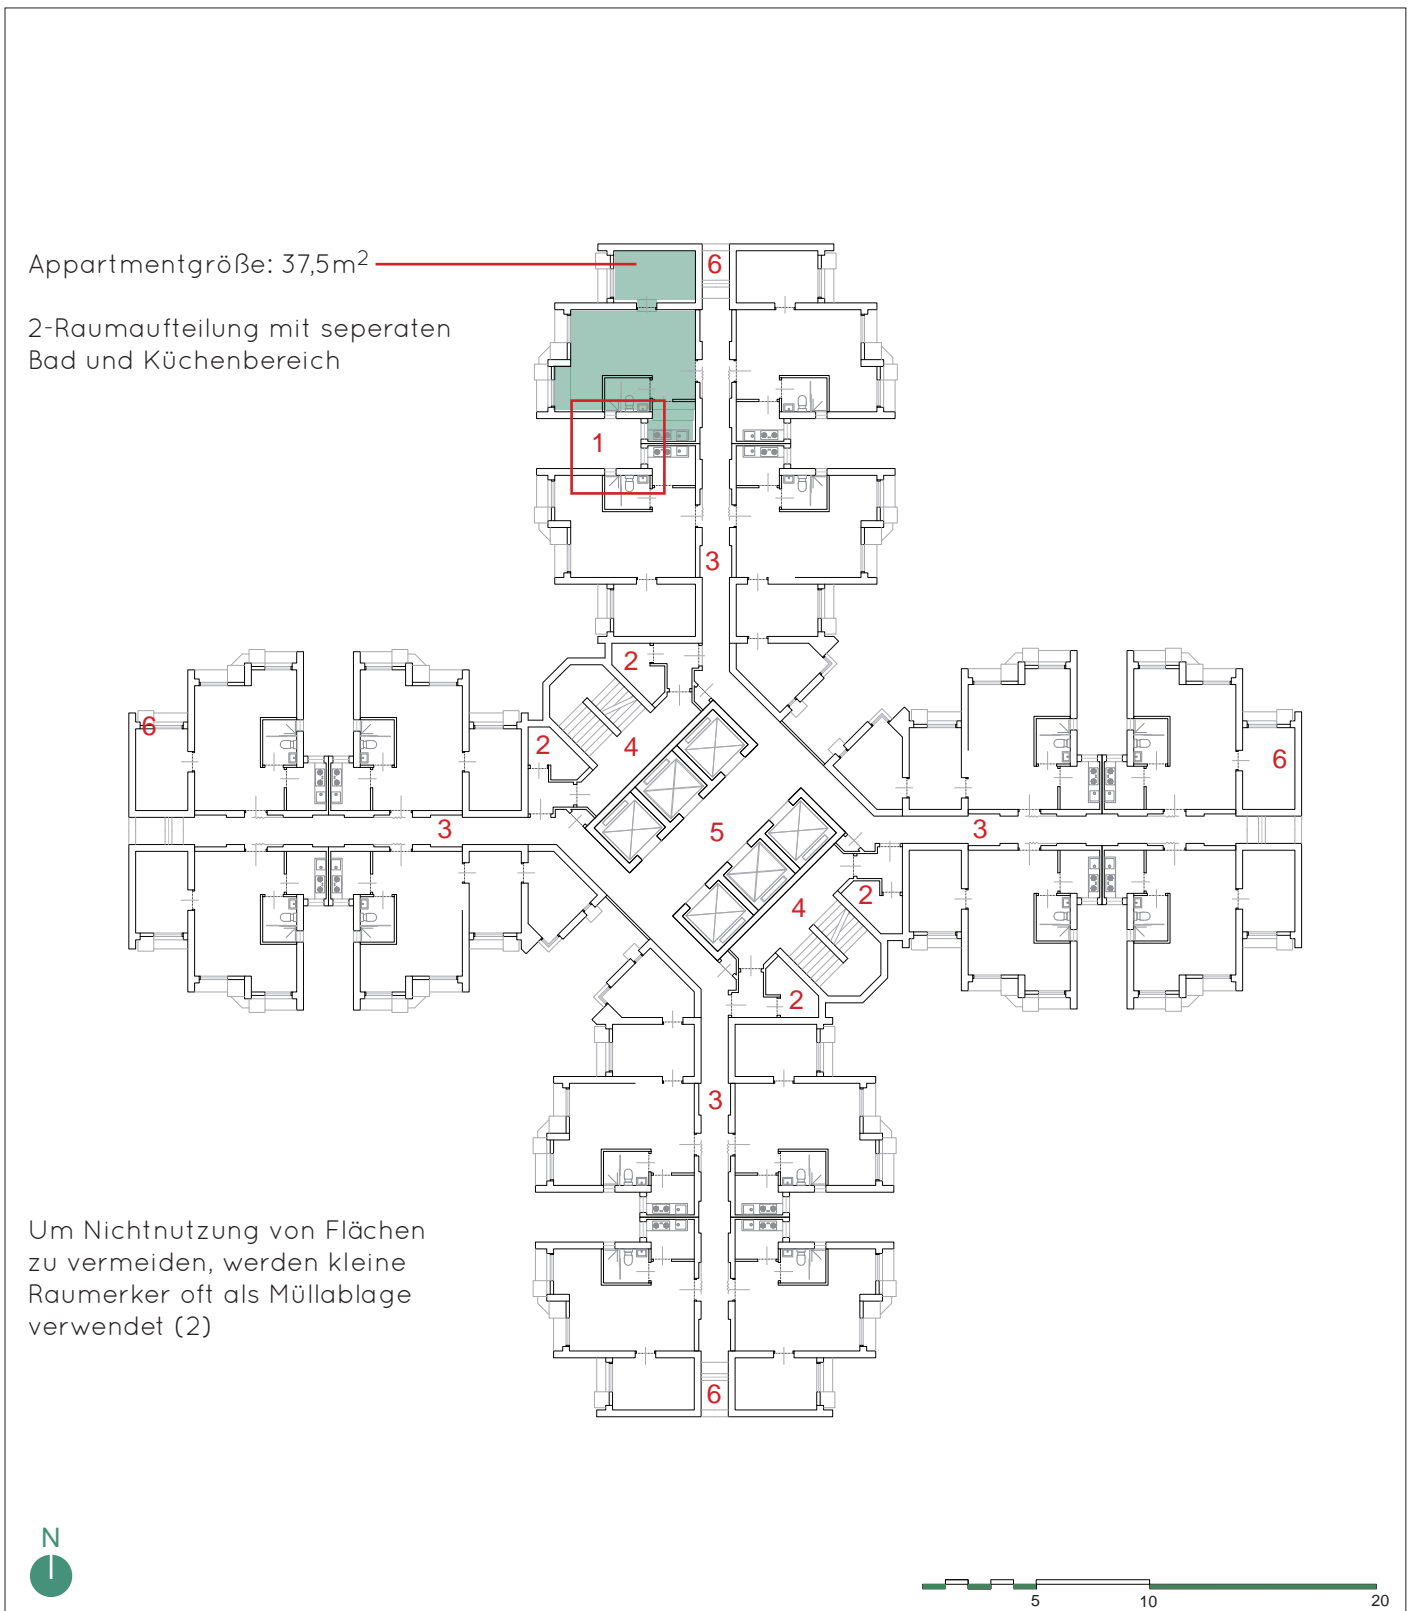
Grundrissplan - Regelgeschoss 1 OG - Oi Ping
